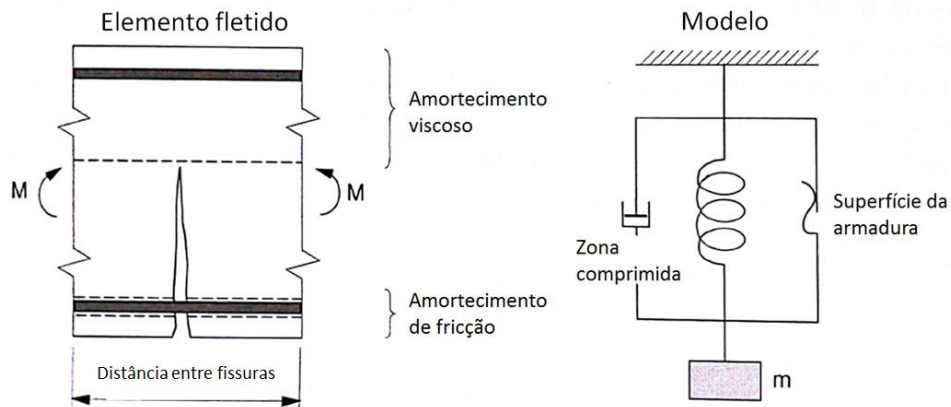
Elemento fletido fissurado e modelo de amortecimento material para o concreto armado (traduzido de BACHMANN et al. (1997))
